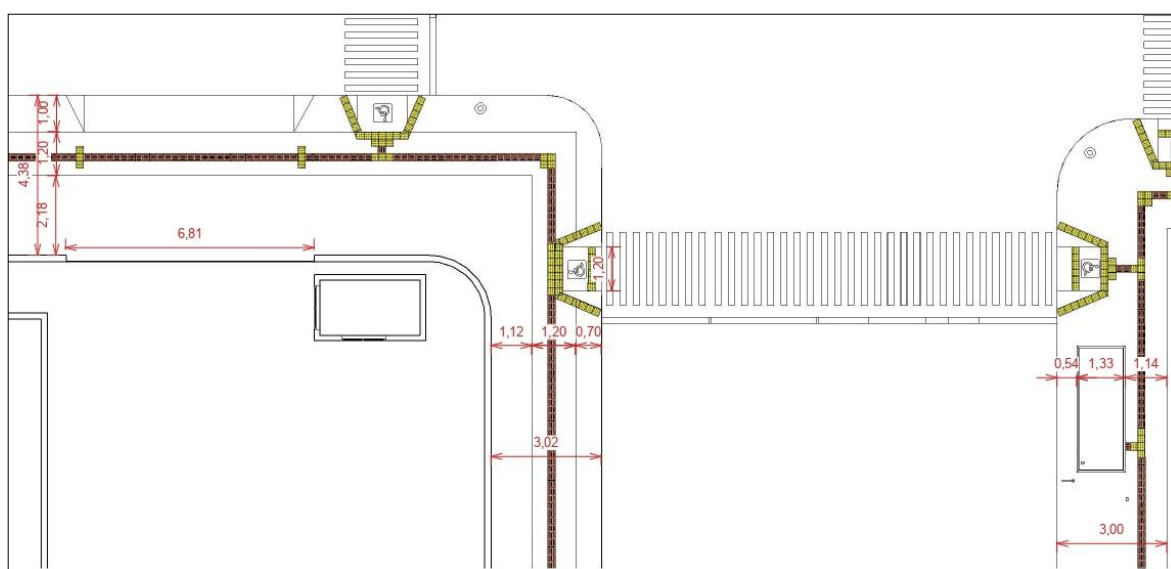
Corte, planta baixa de acessibilidade nas calçadas – 3D. Fonte: Autores (2025).
